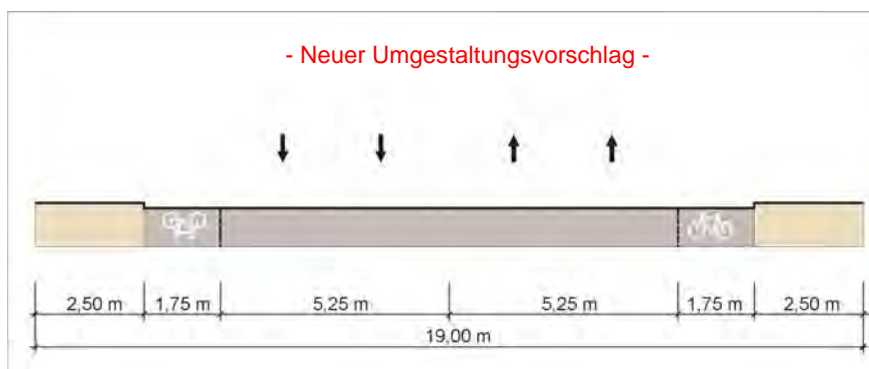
Äußere Münchener Straße – Abschnitt Am Gries/Brückenberg
